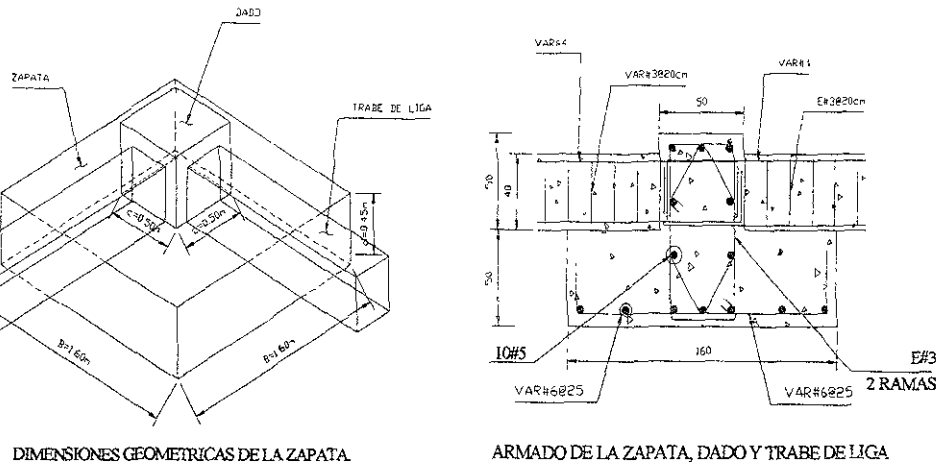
Dimensiones y armado de la zapata para el tanque elevado
